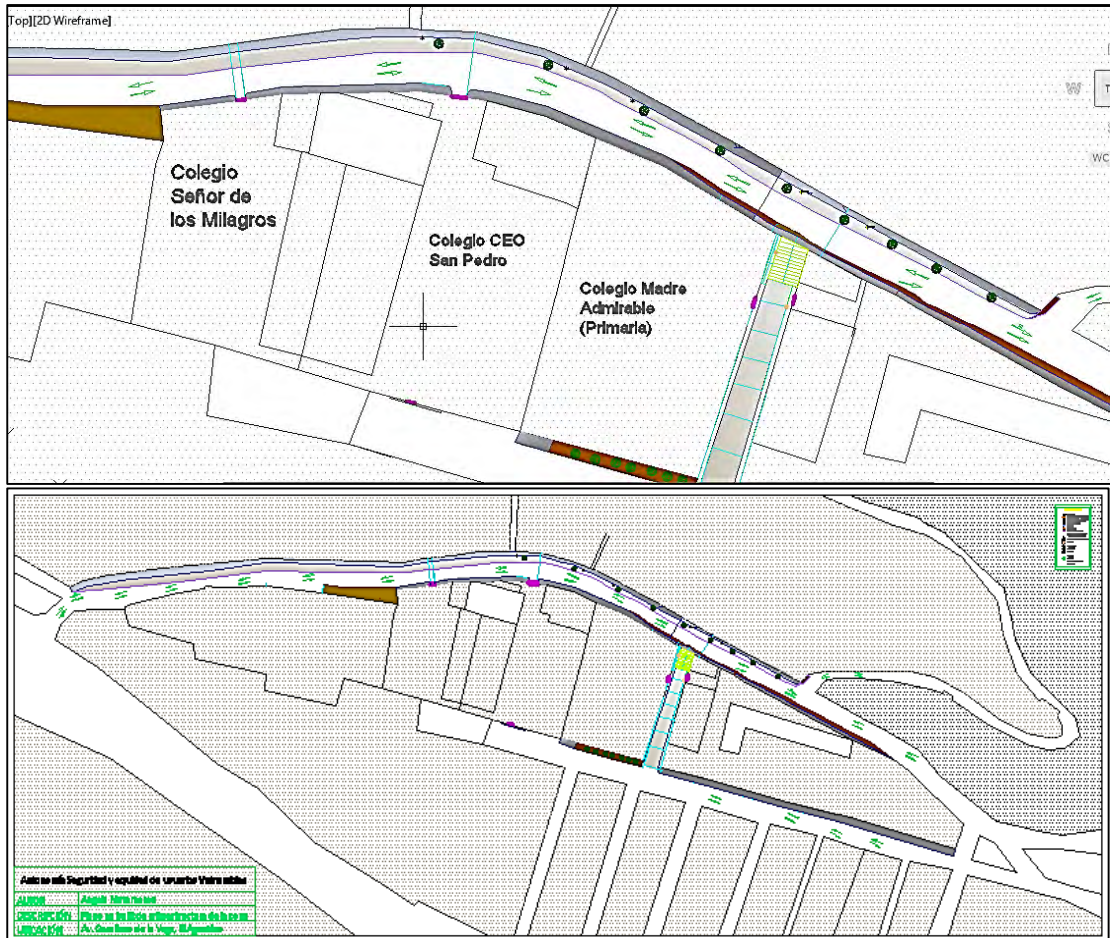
Planos en AutoCAD contruidos con los datos del levantamiento topográfico. Fuente: elaboración propia.
